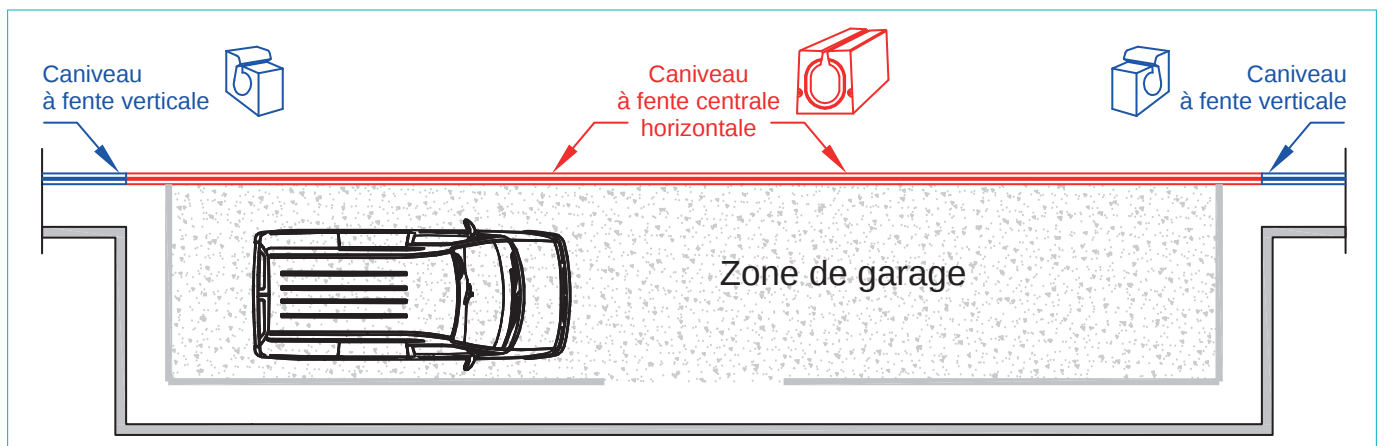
Aménagement du caniveau au droit de la zone de garage
